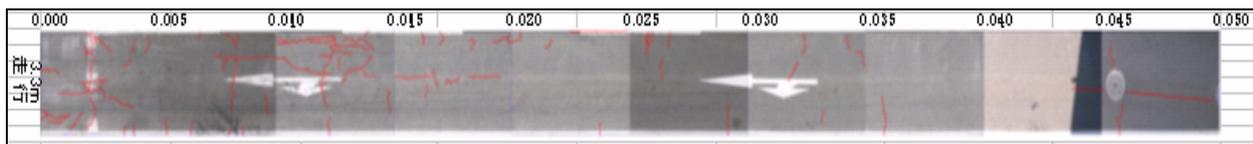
ひび割れ状況図 ①写真とひび割れ図の合成
